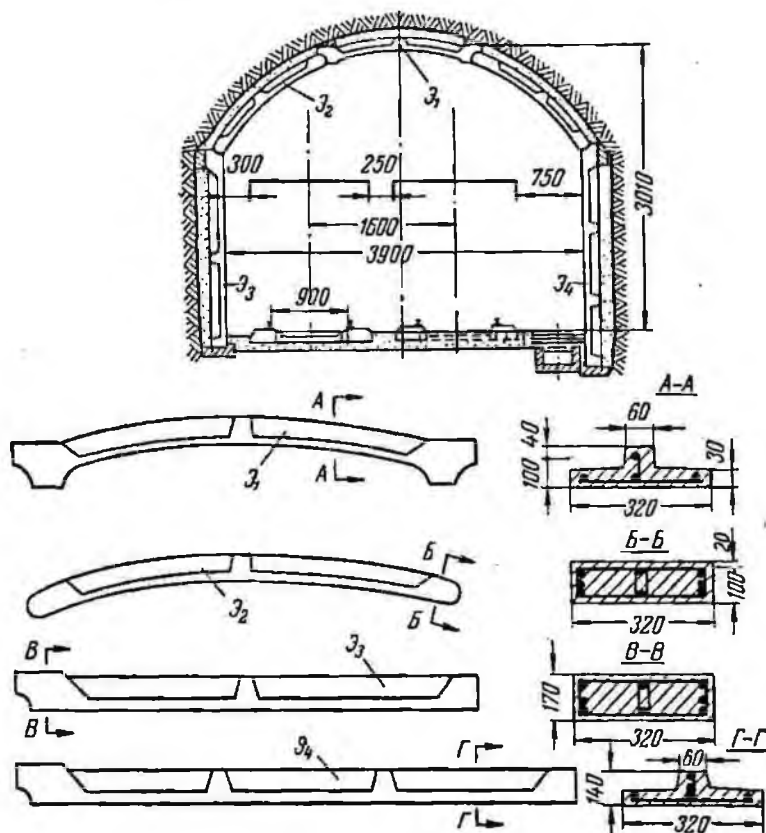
Арочная гладкая крепь из сборного железобетона (АГК)
